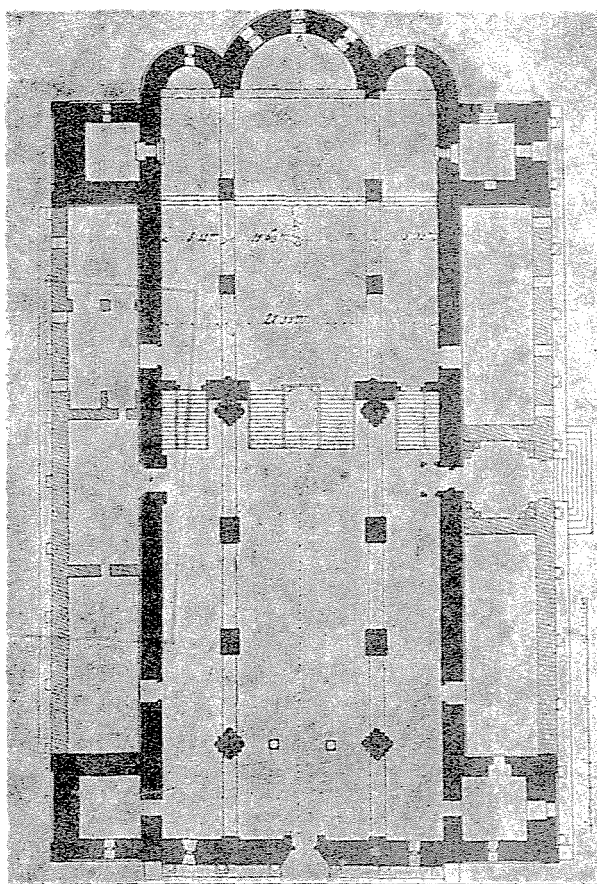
Grundriß der Rekonstruktion nach Schmidt's Plau
